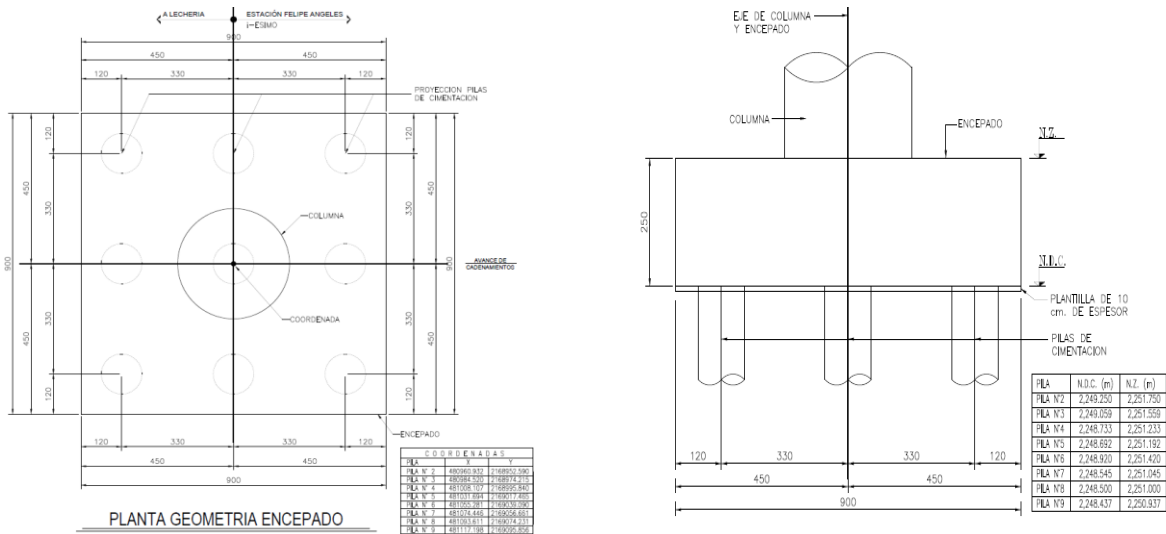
y 83 ARI Ingeniería (2023) "Geometría de zapatas para apoyos intermedios"
